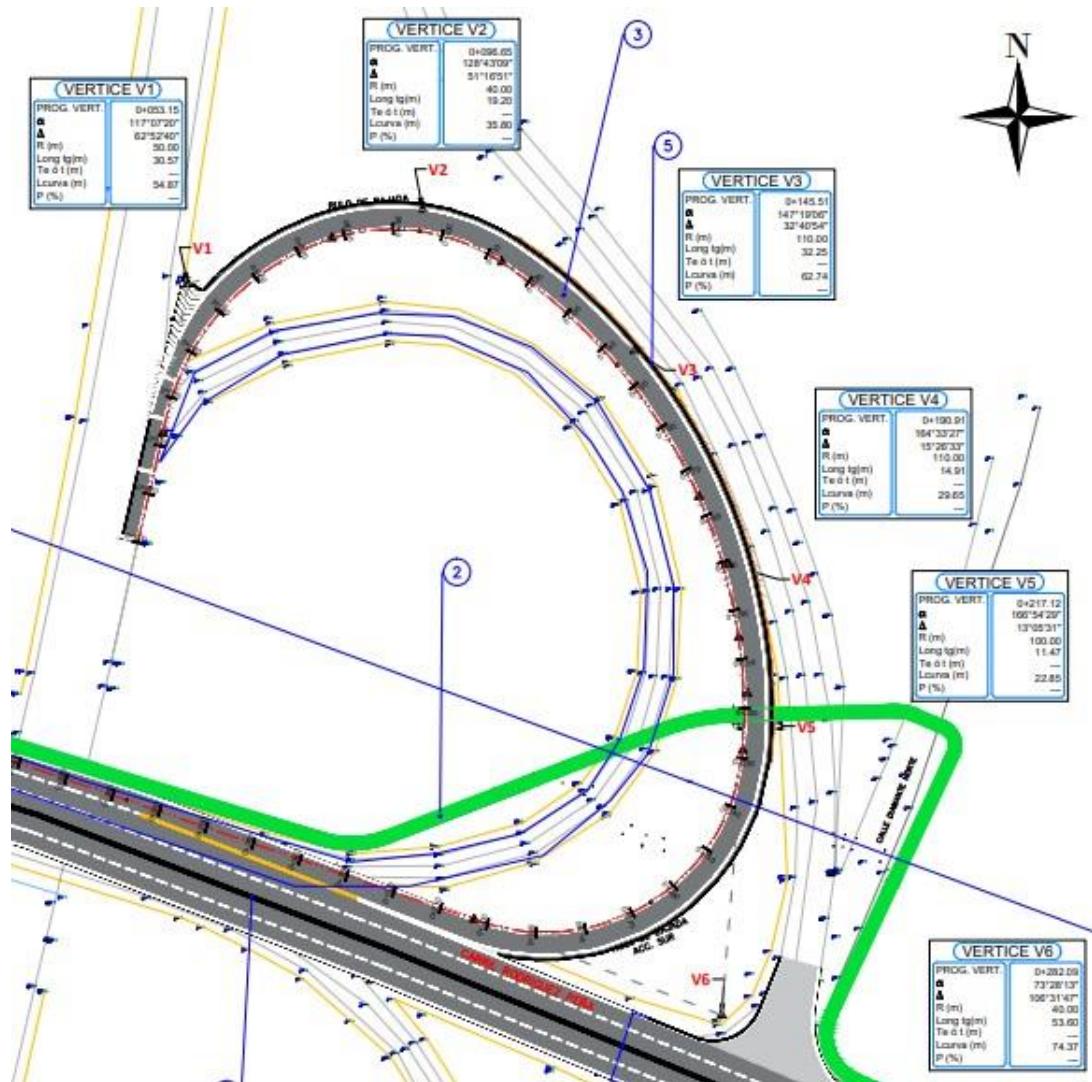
Planimetría de Rulo de Bajada Acceso Sur.
